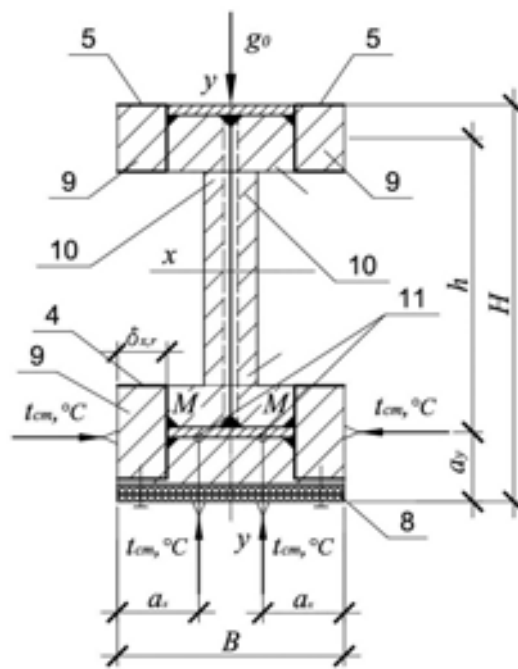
Огнезащищенный сварной двутавр стальной балки (полки которого оборудованы гнутыми стальными швеллерами – каркас термозащитного пояса): 1 – растянутая полка; 2 – сжатая полка; 3 – гофрированная стенка; 4 – швеллеры растянутой полки; 5 – швеллеры сжатой полки; 6 – сварной шов; 7 – антикоррозионное покрытие сварного двутавра; 8 – гипсокартонные листы; 9 – минватная плита термозащитного пояса полки сварного двутавра; 10 – минватная плита термозащитного пояса гофрстенки; 11 – контрольные точки растянутой полки сварного двутавра; t , ст $^{\circ}\text{C}$ – направление подвода тепла в условиях огневого испытания; g_0 – линейная испытательная нагрузка на несущую балку с гофрированной стенкой, кН; $H \times B$ – общая высота и ширина балки с гофрированной стенкой с огнезащитной облицовкой, мм; a_x и a_y – глубина заложения контрольной точки поперечного сечения сварного двутавра балки с гофрированной стенкой по осям x и y , мм; $\delta_{x,r}$ – толщина огнезащитной облицовки сварного двутавра балки с гофрированной стенкой, мм
